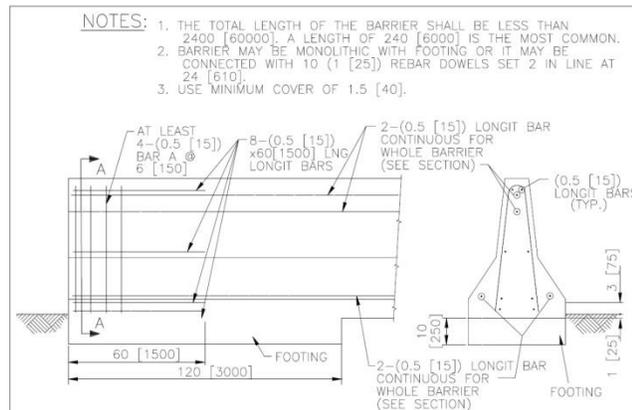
Plano constructivo barrera Tipo F. Fuente: FHWA, 2011
